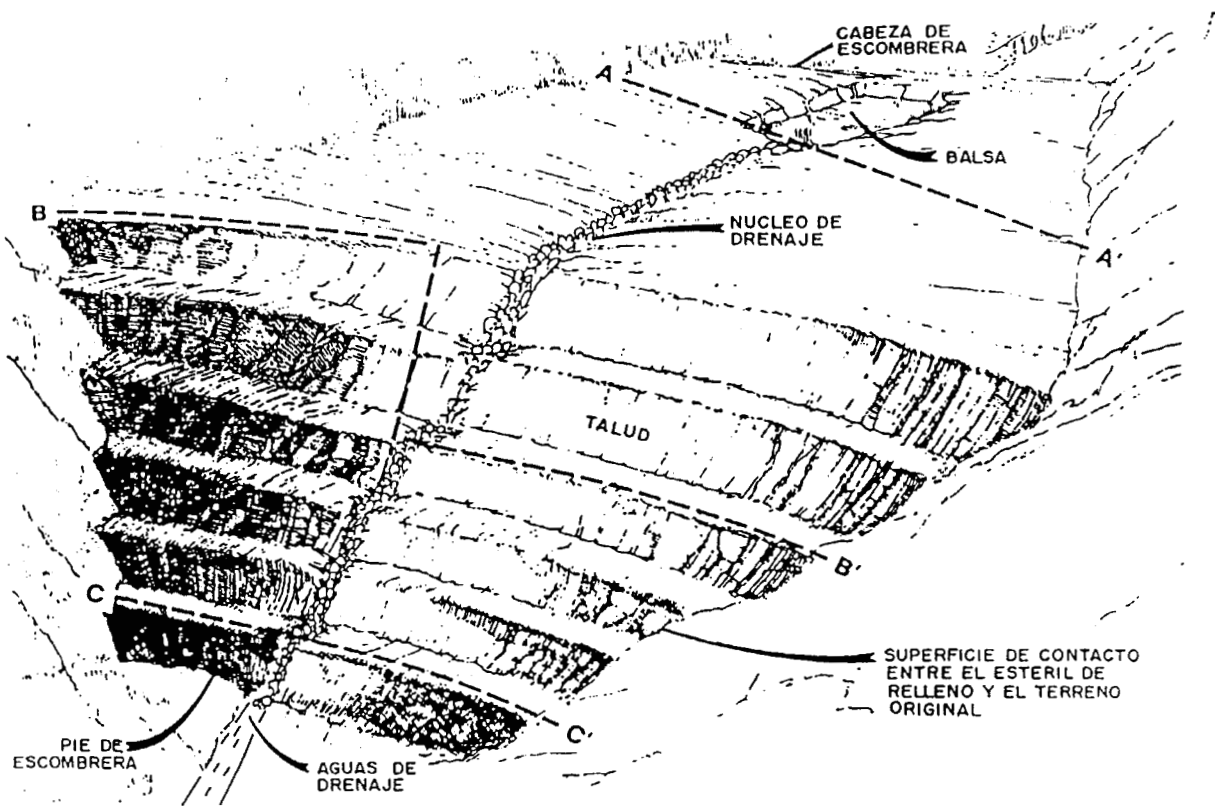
Detalles constructivos de una escombrera de vaguada con núcleo de drenaje.
